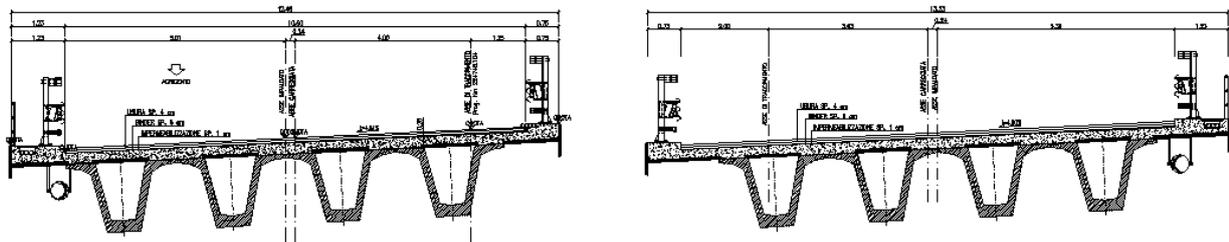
Sezioni impalcato progetto esecutivo.
